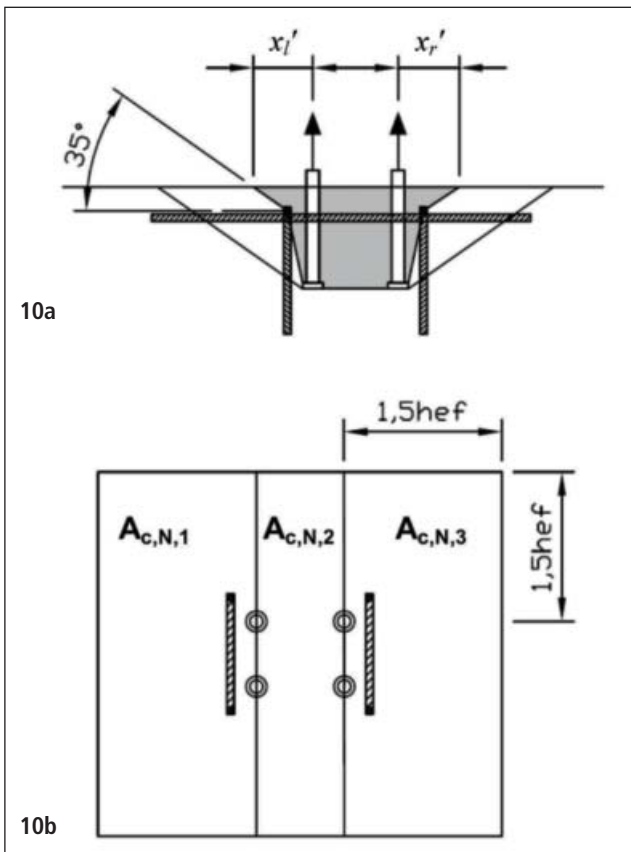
Zugbeanspruchte Gruppe mit vier Kopfbolzen, nach Berger [10]; a: Kopfbolzen mit Rückhängebewehrung und angenommenen Ausbruchskörpern, b: projizierte Fläche
